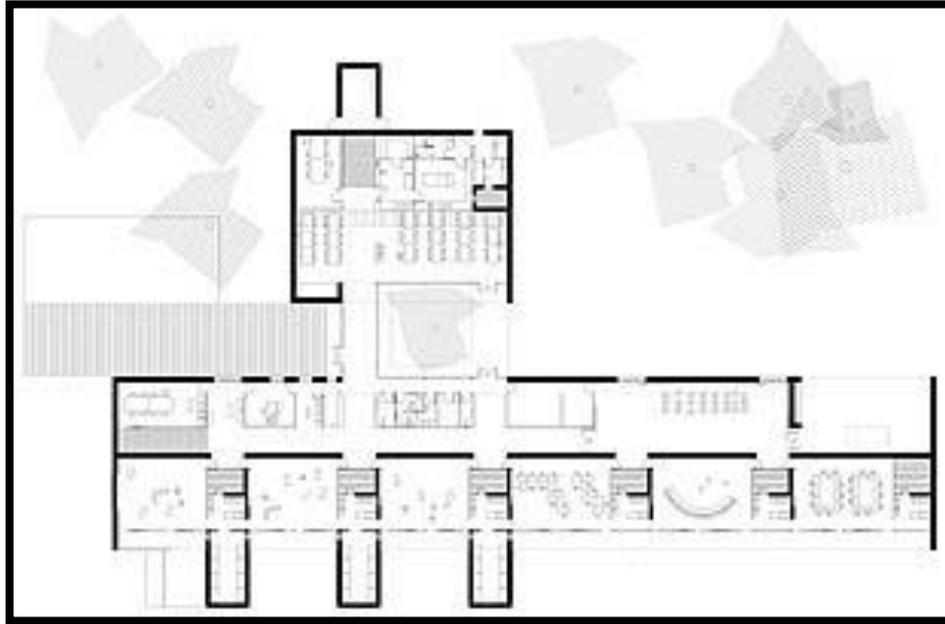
Planta arquitectónica de la Escuela Infantil.
